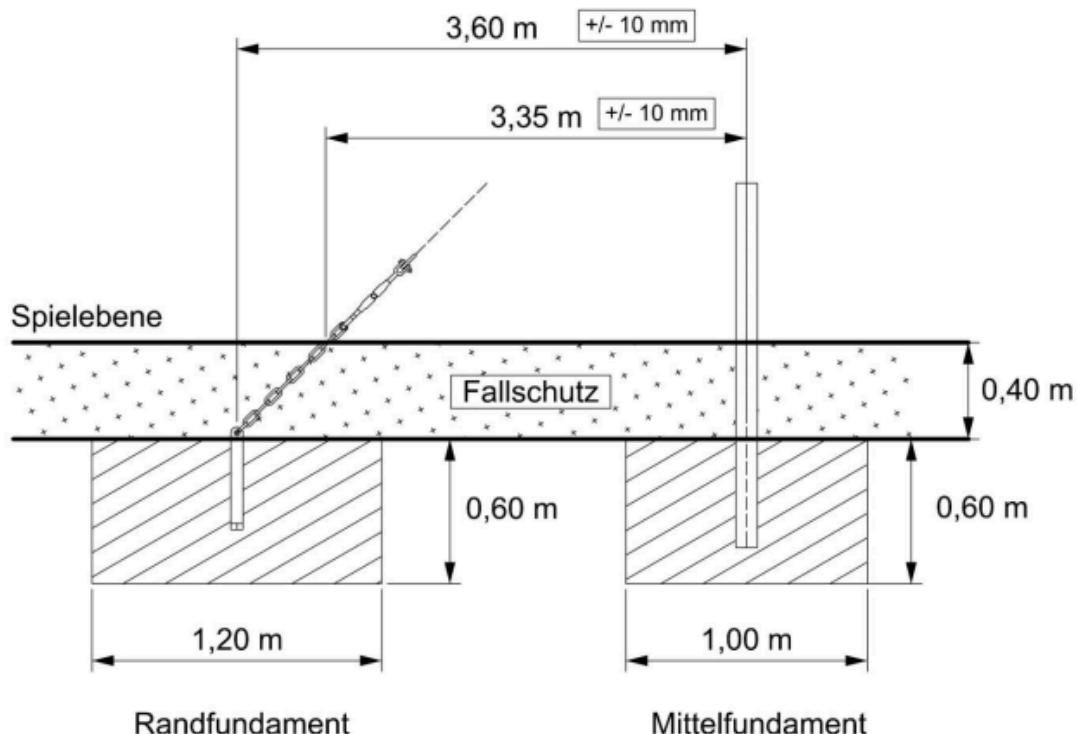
Sezione verticale della fondazione perimetrale (Randfundament)
